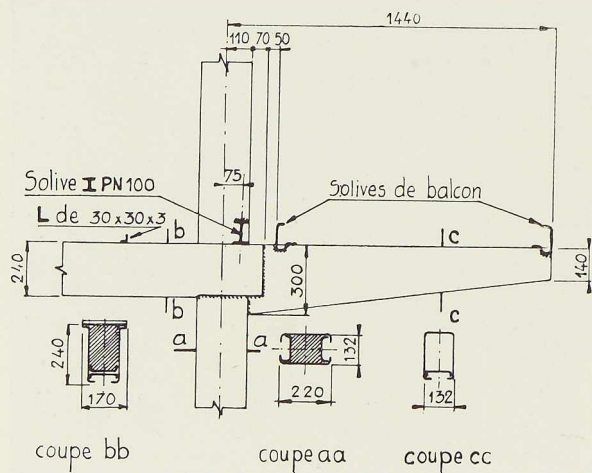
Détail d'assemblage d'une console de balcon à un portique.
